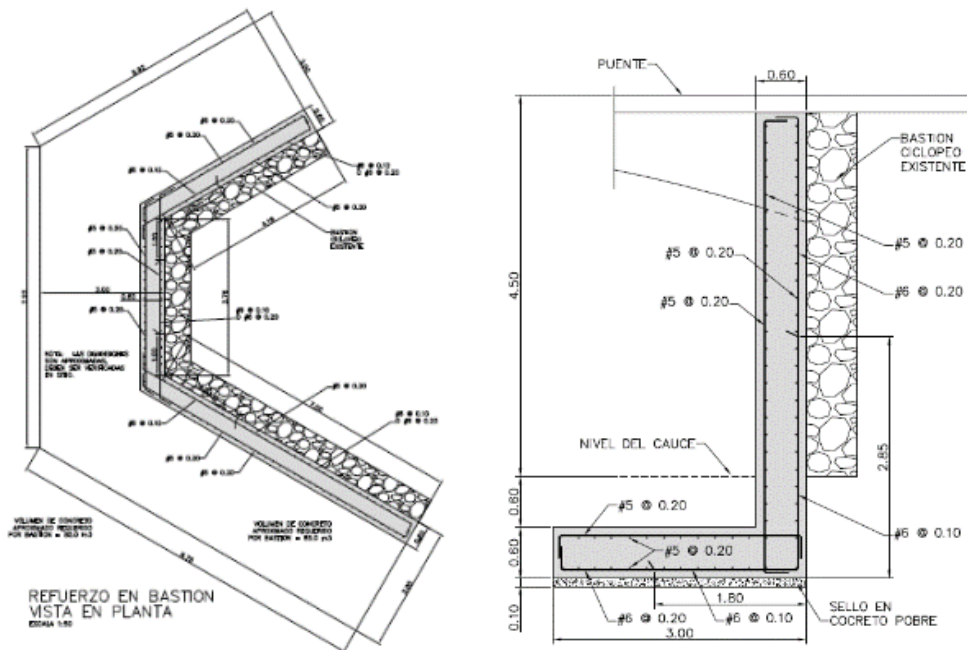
Detalles de muro de refuerzo externo según lámina ES-01 DE 01
